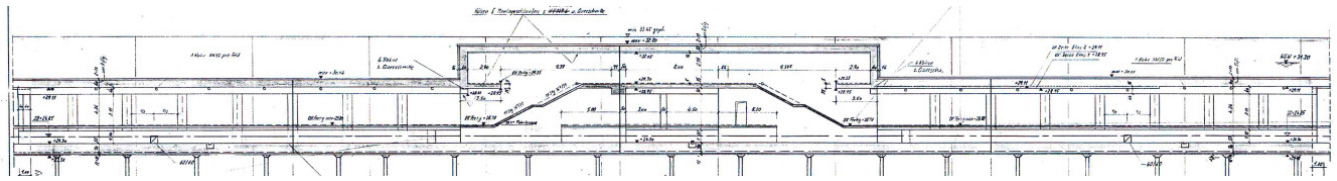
Grundriss der Bahnsteigebene, wird vollständig im Brandschutzkonzept betrachtet
